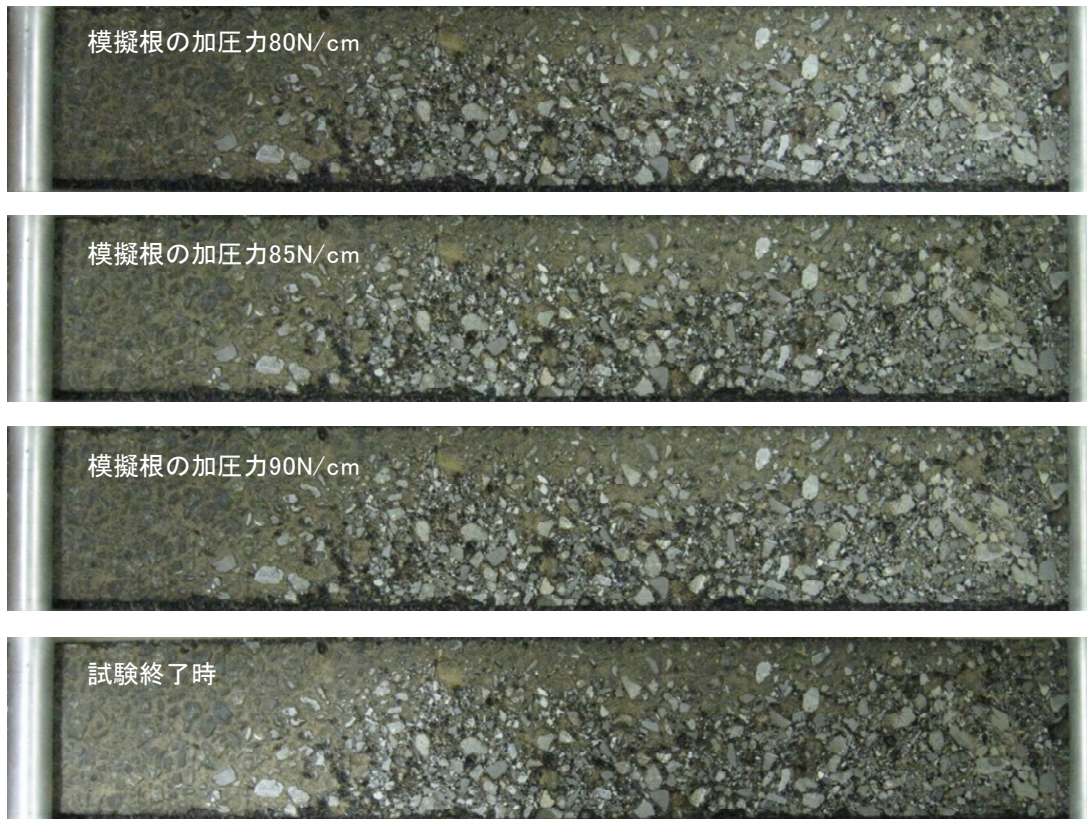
アスファルト舗装表面のひび割れ状態の一例(模擬根直上の砂層の厚さ50mm) 3/3
